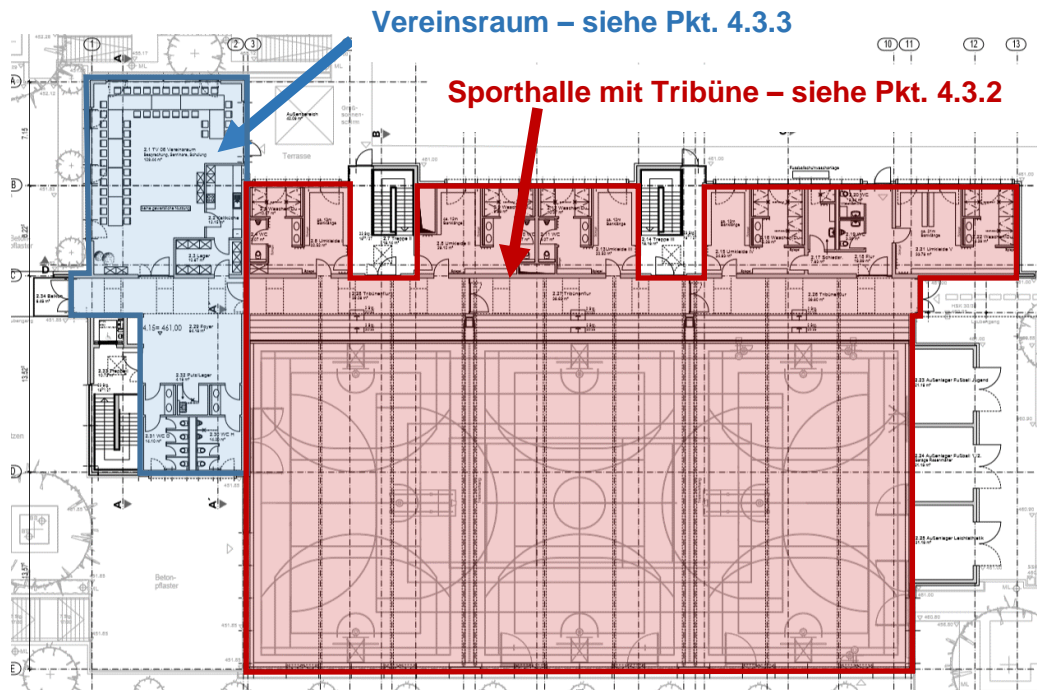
Grundriss Geschossebene 2/OG – Übersicht Nutzungsbereiche
